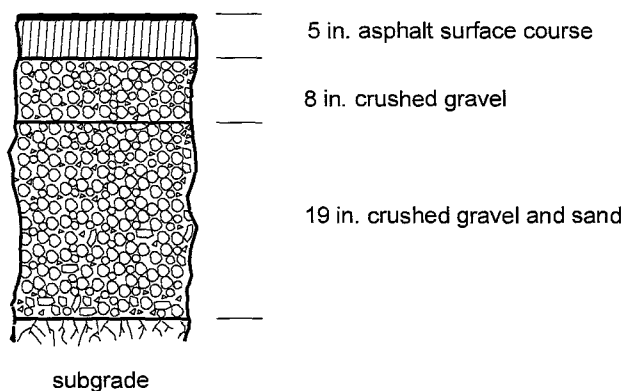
Ejemplo de Sección Transversal de Pavimento Flexible.
